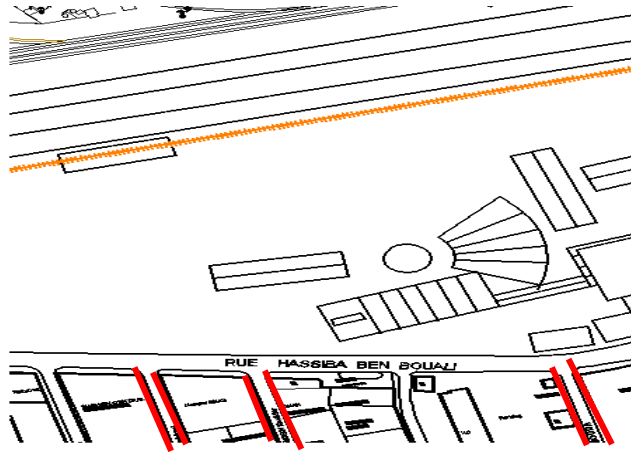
vue en plan sur les axes transversaux avant l'intervention
